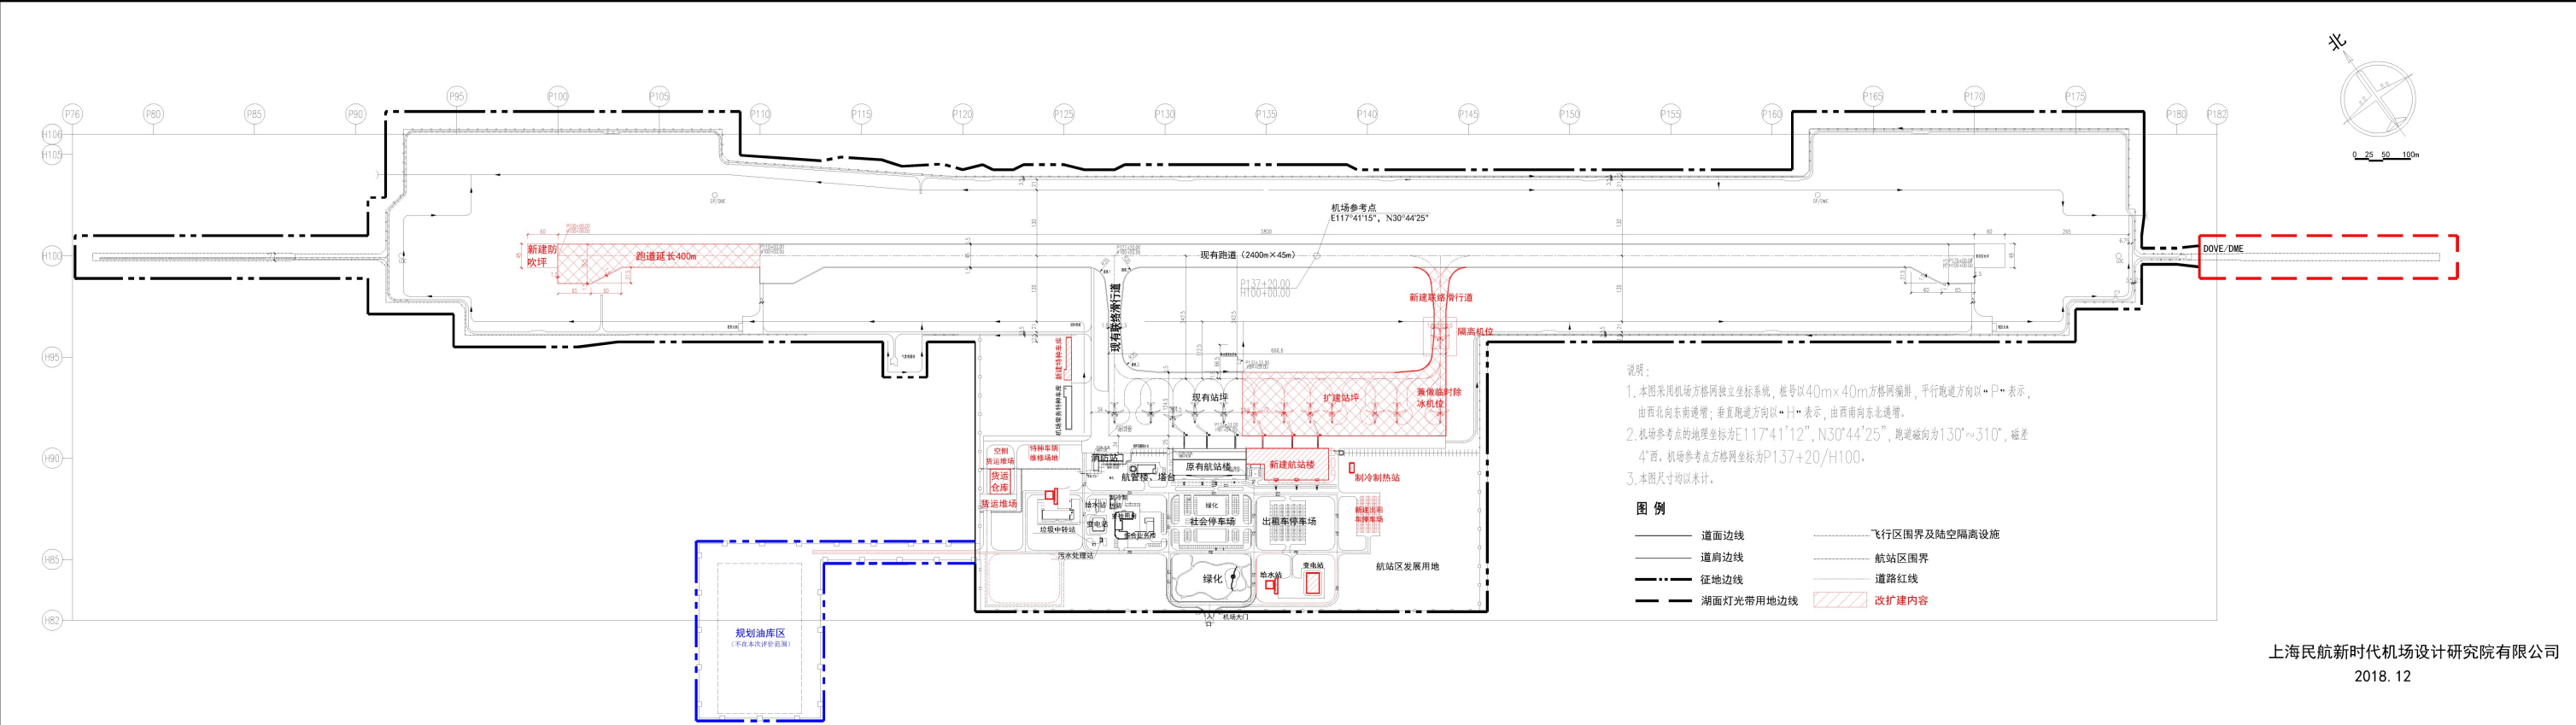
池州九华山机场改扩建完成后总平面布置图
